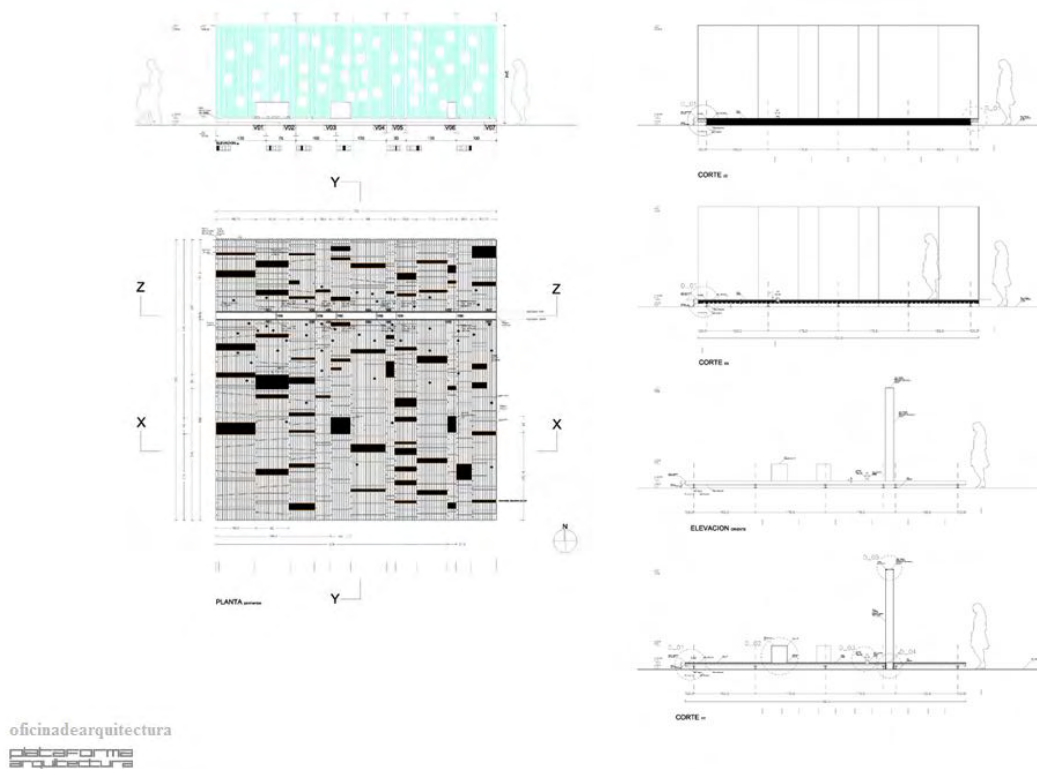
Planos de planta del proyecto Mujeres en la Memoria.
